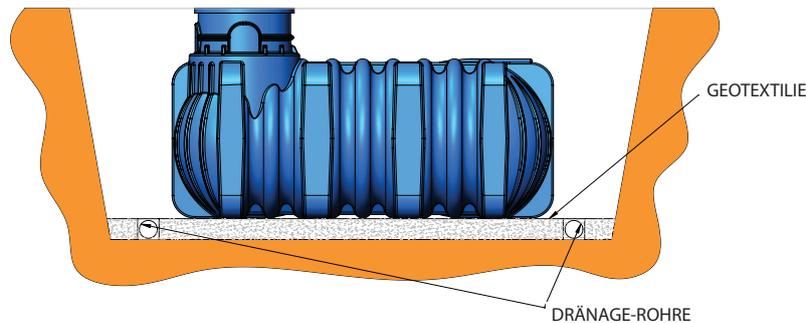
Behältereinbau in schlecht durchlässige Bodenflächen
